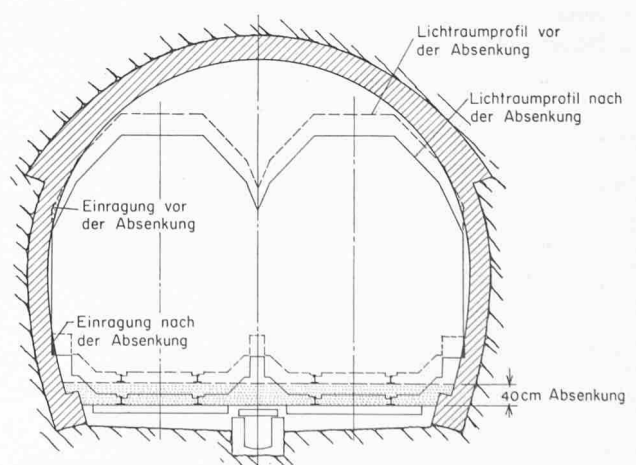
Einragung in das Lichtraumprofil und Entblössung der Widerlagerfundamente als Folge der Geleiseabsenkung im Wipkingertunnel und anderen Tunnel
